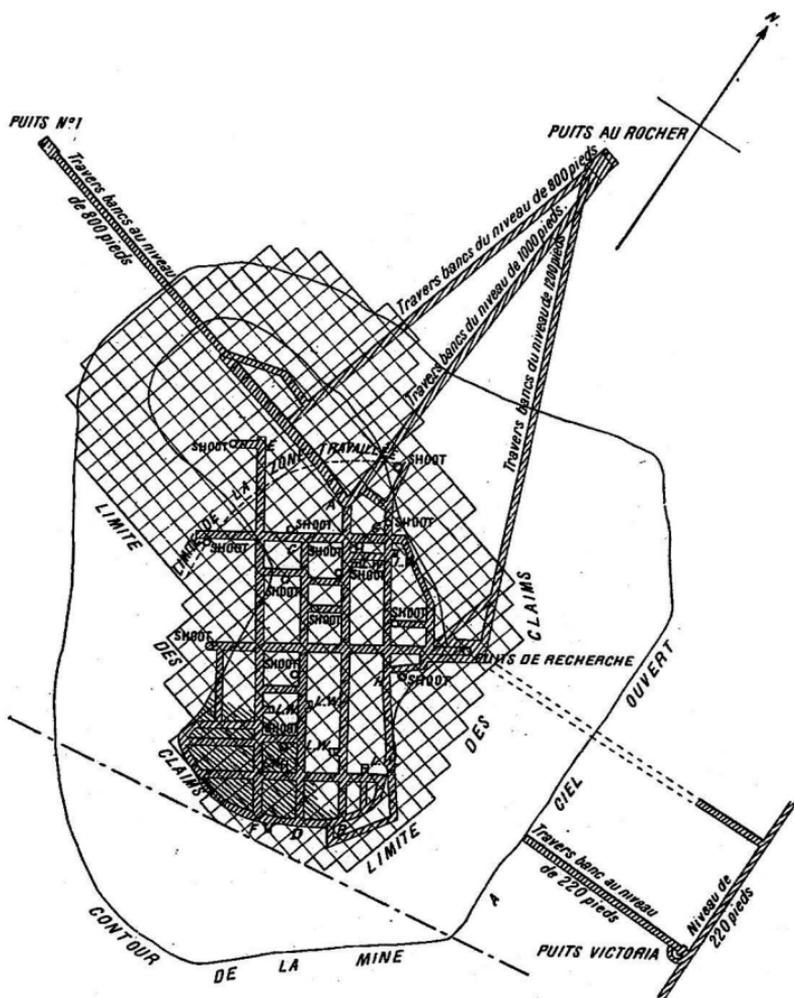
Plan de la mine de Beers au niveau de 1 000 pieds (juin 1896).
